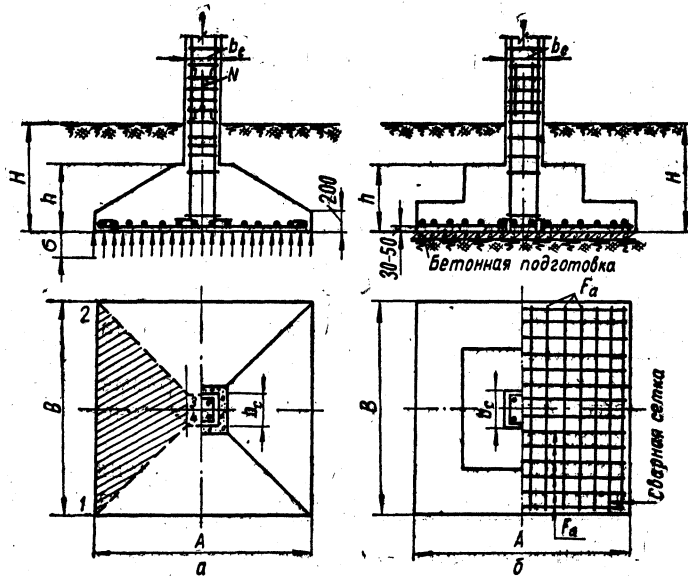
Фундаменты монолитные под монолитные колонны:
